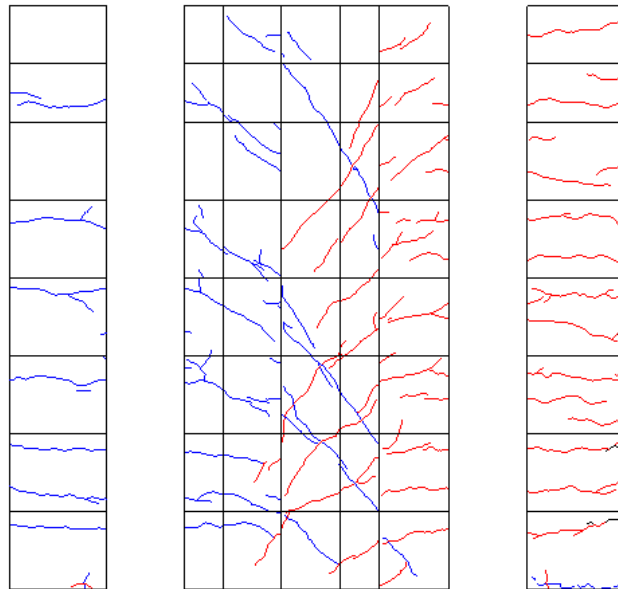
R=1/100 ひび割れ図
